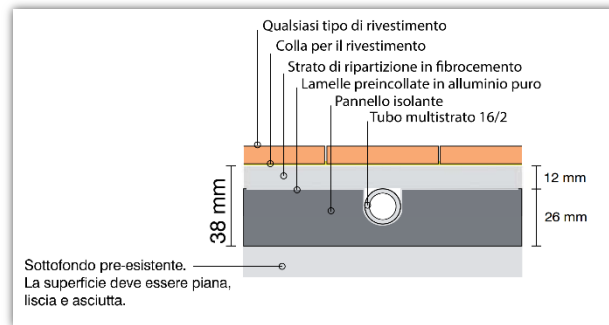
Esempio di stratigrafia, riscaldamento a pavimento radiante a secco
